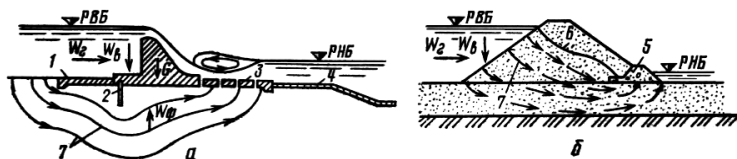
Схема дії води на бетонну (а) і ґрунтову (б) греблі і їх основу:
